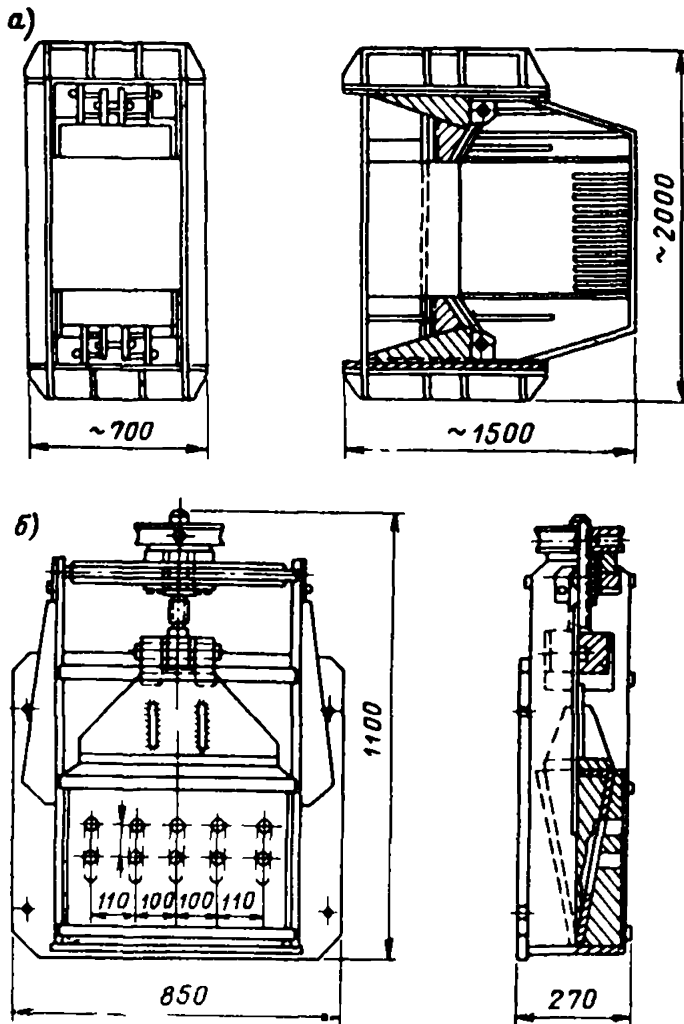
Клиновое устройство для отпуска натяжения арматуры, натягиваемой на упоры стенда
